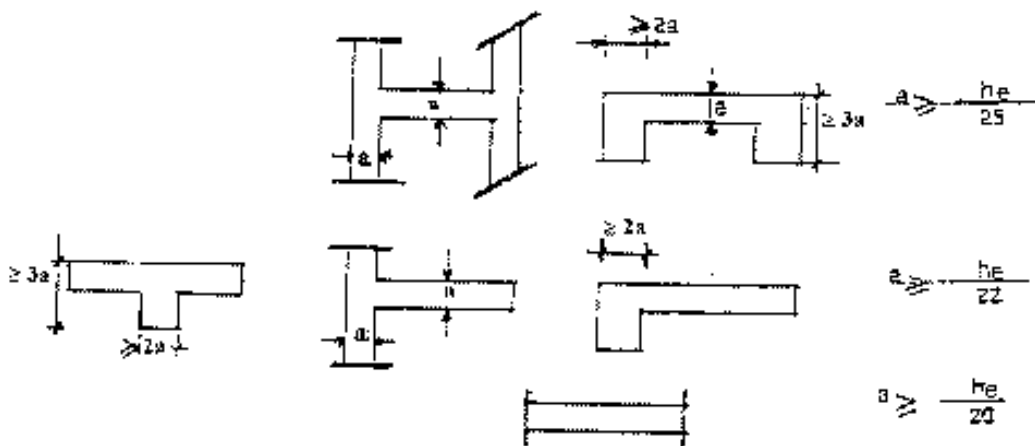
Coupe des différentes formes d'un voile en plan.
